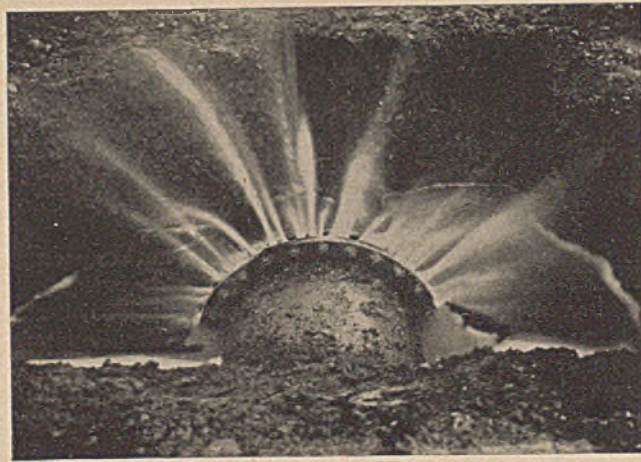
Undichte Flanschdichtung der ersten Ausführung.
